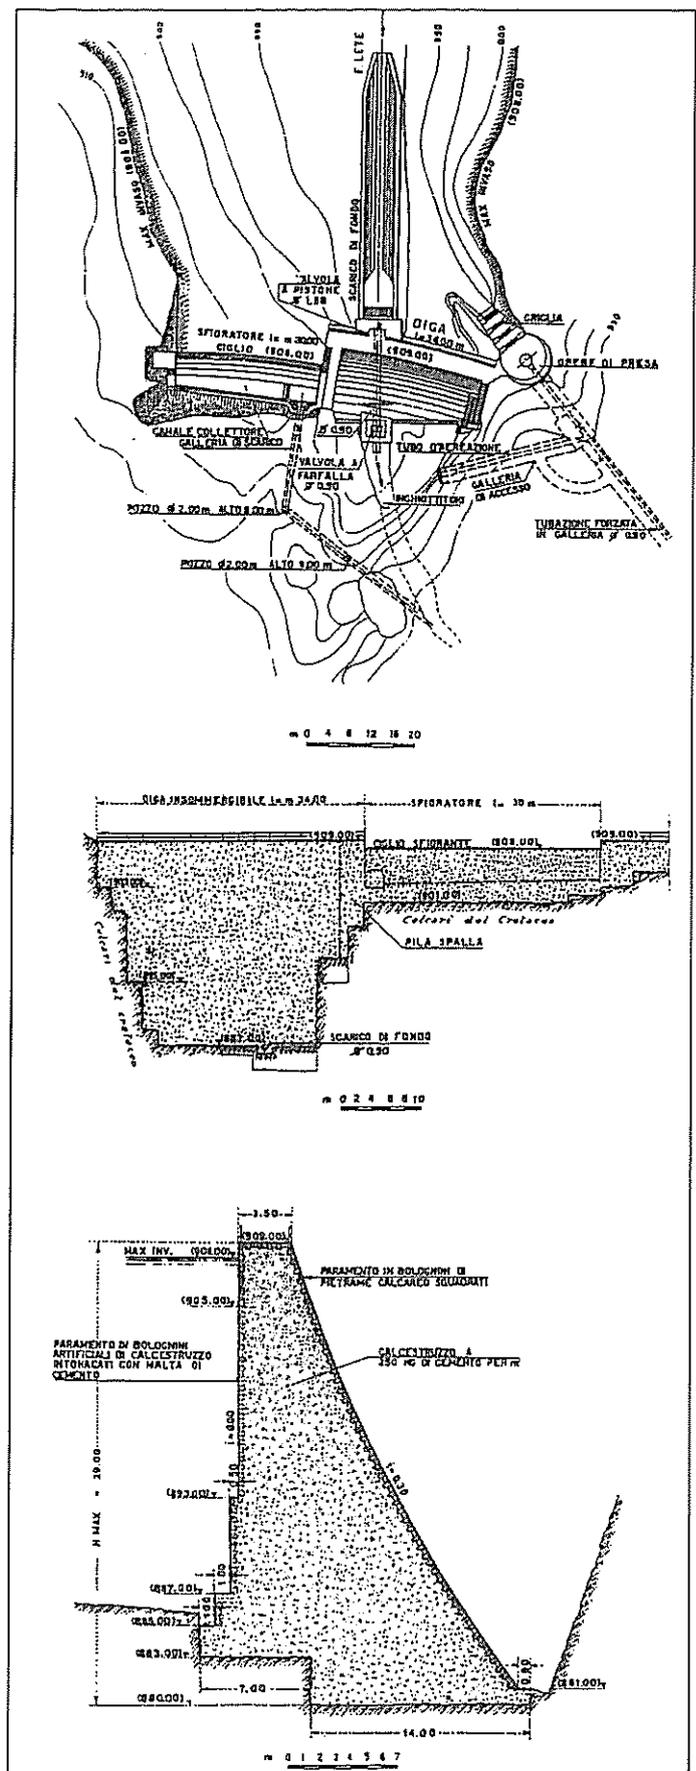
Diga Lago Letino: Planimetria - Vista da monte - Sezione tipo.
